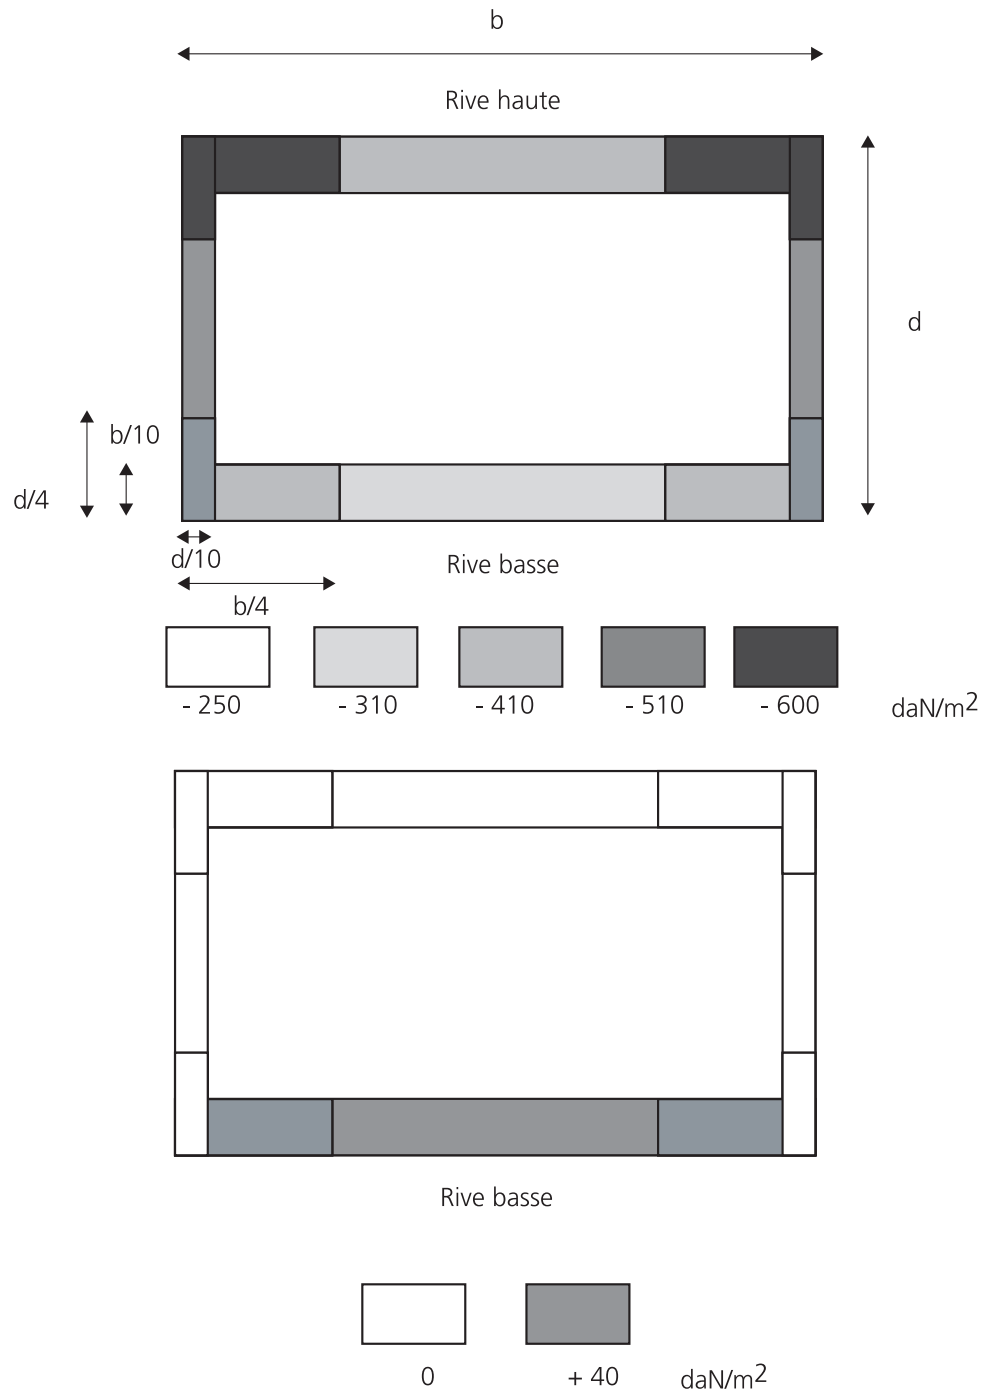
Charges forfaitaires d'arrachement et d'écrasement sur une toiture à un versant de pente = 15° - $h \leq 10$ m
